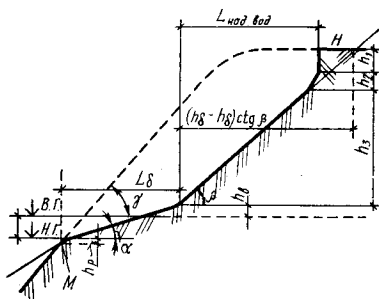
Профиль берегового откоса после переработки (по Е. В. Качугину)
